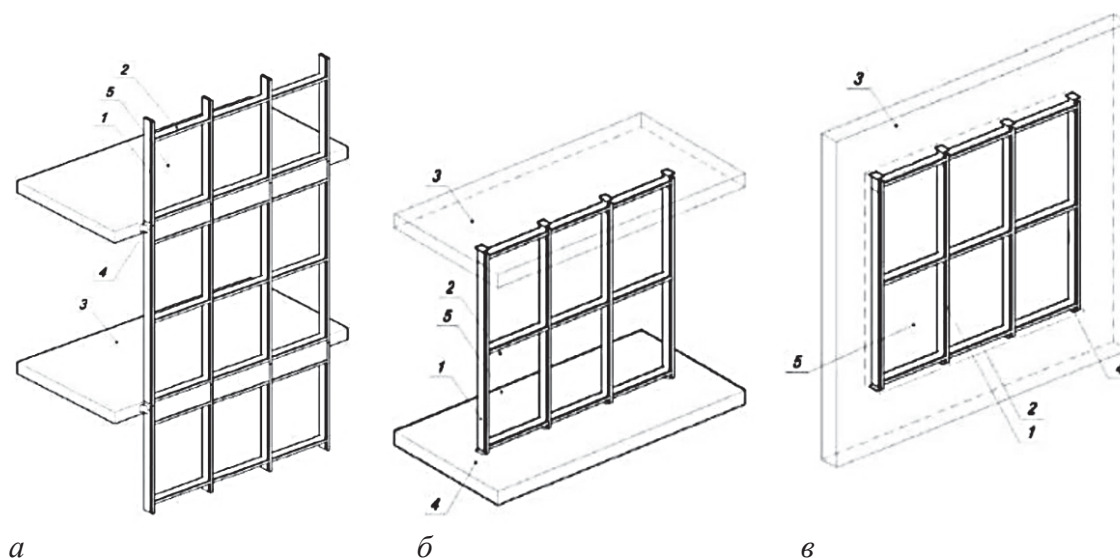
Типы светопрозрачных фасадных конструкций:
